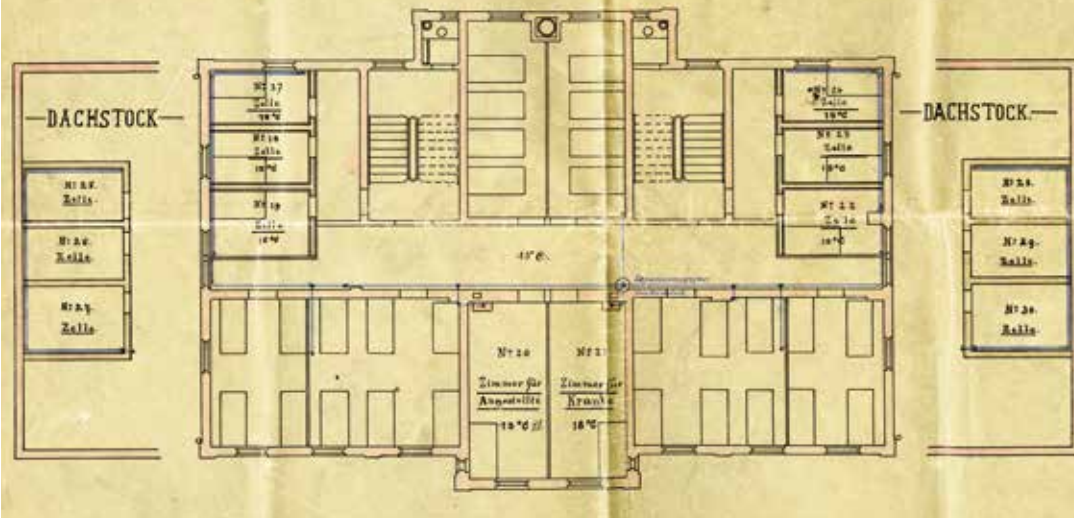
Grundrisspläne des Anstaltsgebäudes 1891.
